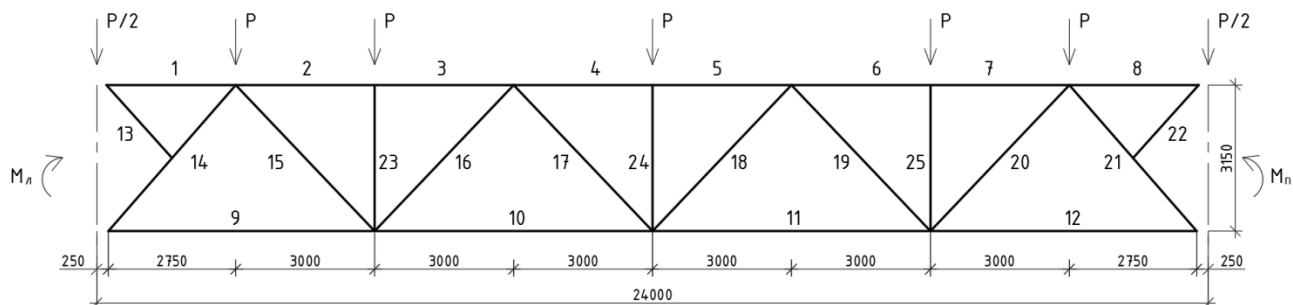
Расчётная схема фермы с поясами из уголков
